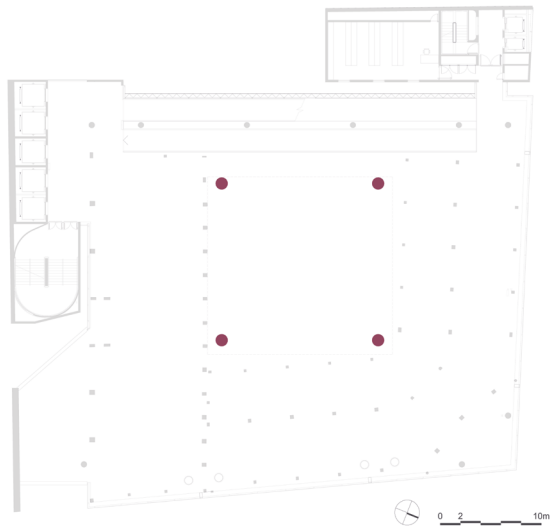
Pilares centrales de sección circular de soporte a la piscina y al teatro. (Autoría propia, 2022).
